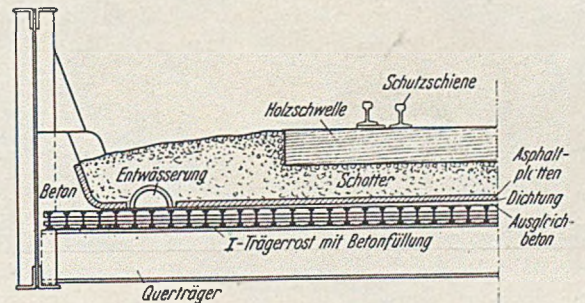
Querschnitt einer Eisenbahnbrücke bei Verwendung eines I-Trägerrostes mit Betonfüllung.
